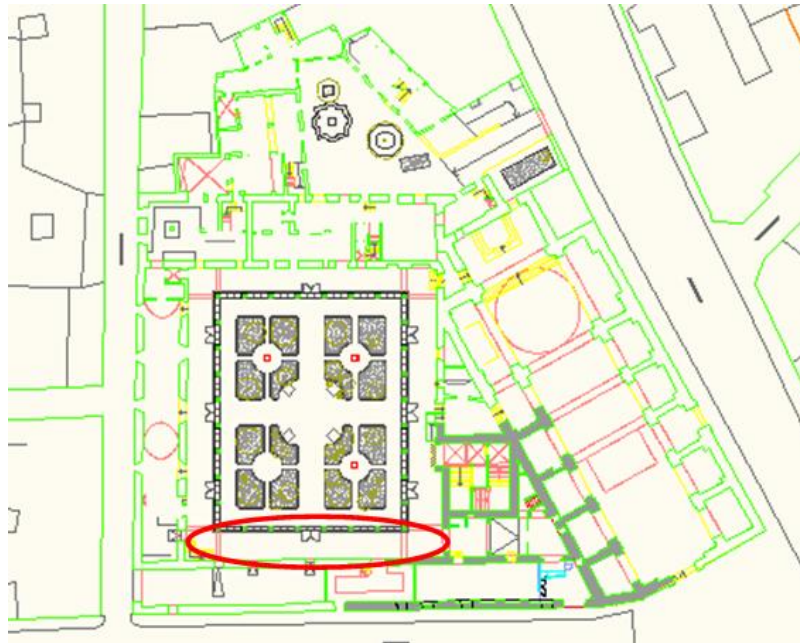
Planta del inmueble con la zona de intervención delimitada.
